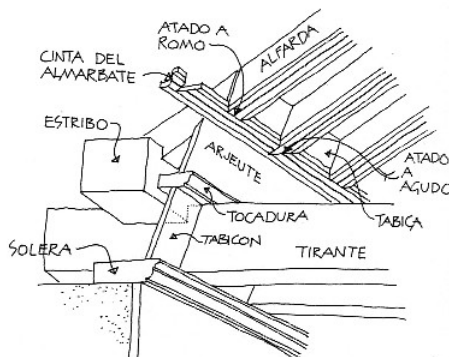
Detalle de las piezas que constituyen el estribado de una armadura de pares.¹⁵⁴
